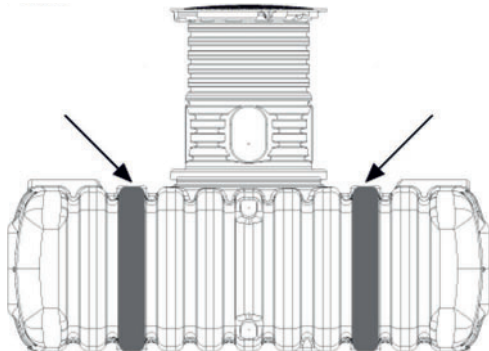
Vue en coupe des tubes de renfort – FLAT S/M
